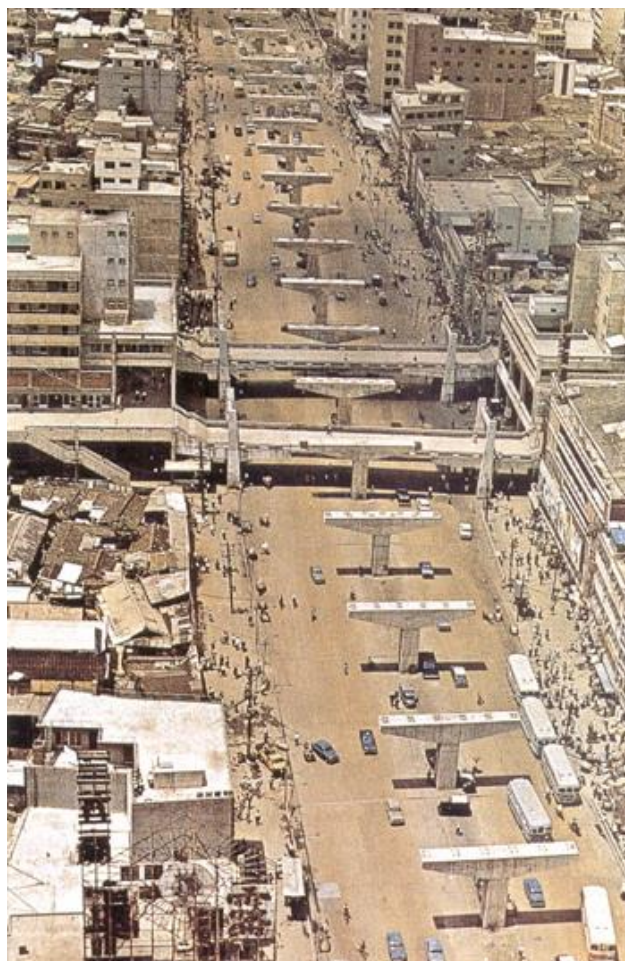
Cobertura do rio e construção da via elevada na década de 60 (fonte: Preservation Institute)
